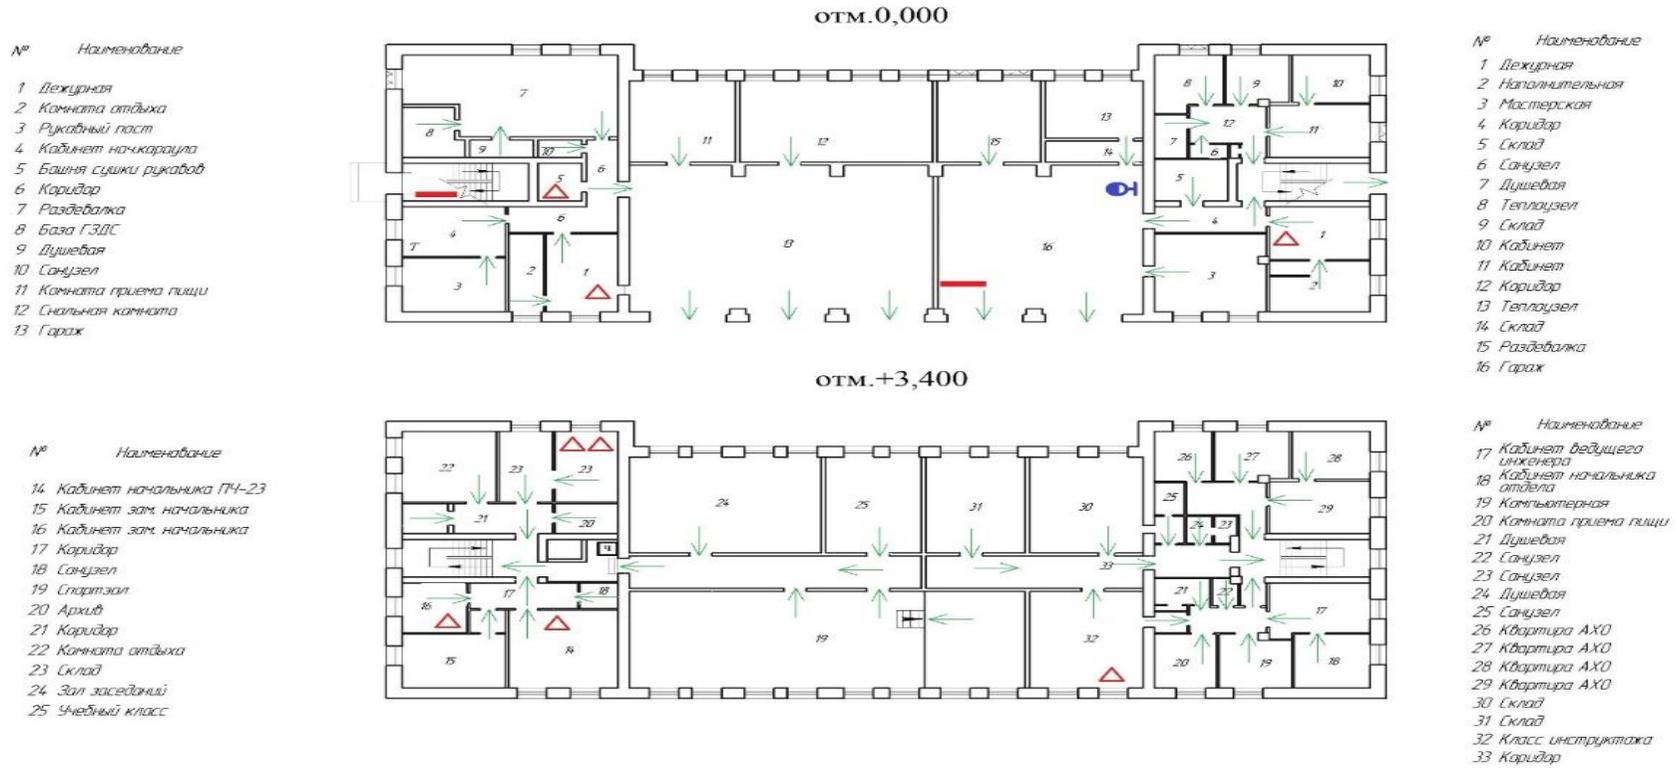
План-схема здания Е-5 пожарное депо
